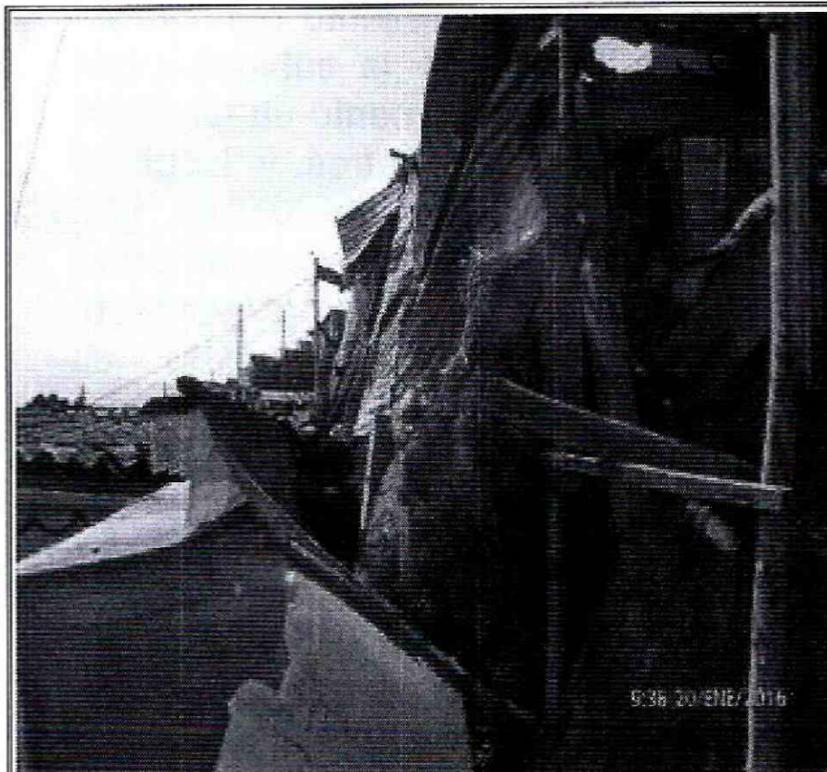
Talud de corte costado oriental predio de la Calle 71 A Sur No. 20 A - 61
